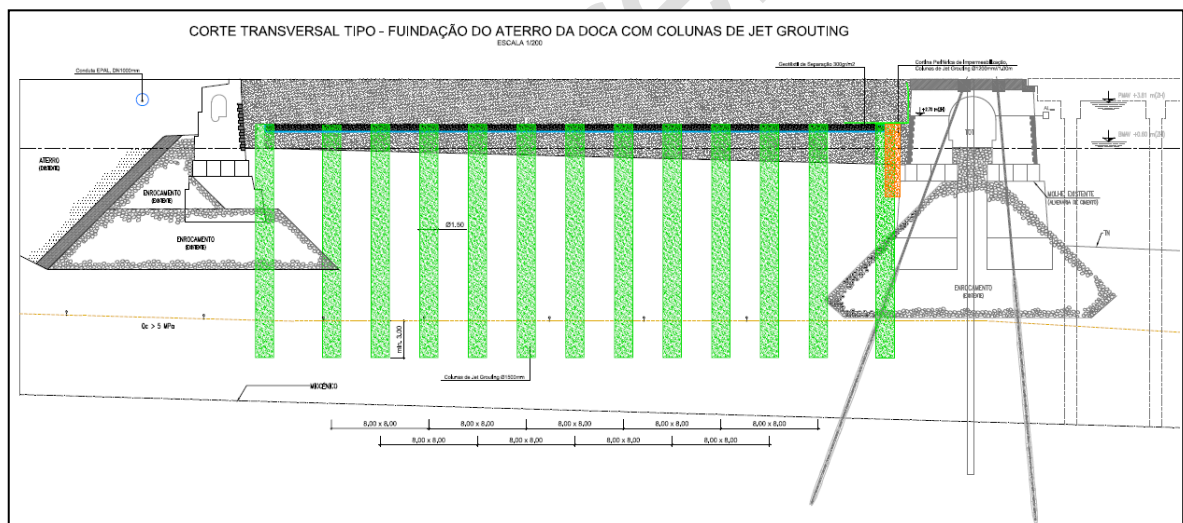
Colunas de “*jet-grouting*” - Perfil tipo.
